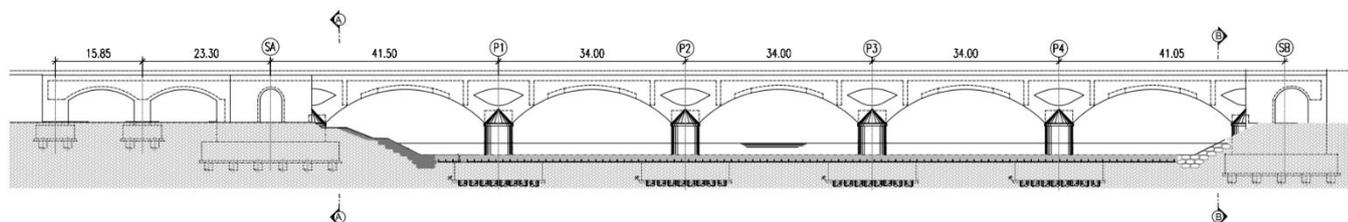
Prospetto nuovo ponte sul Fiume Adige
